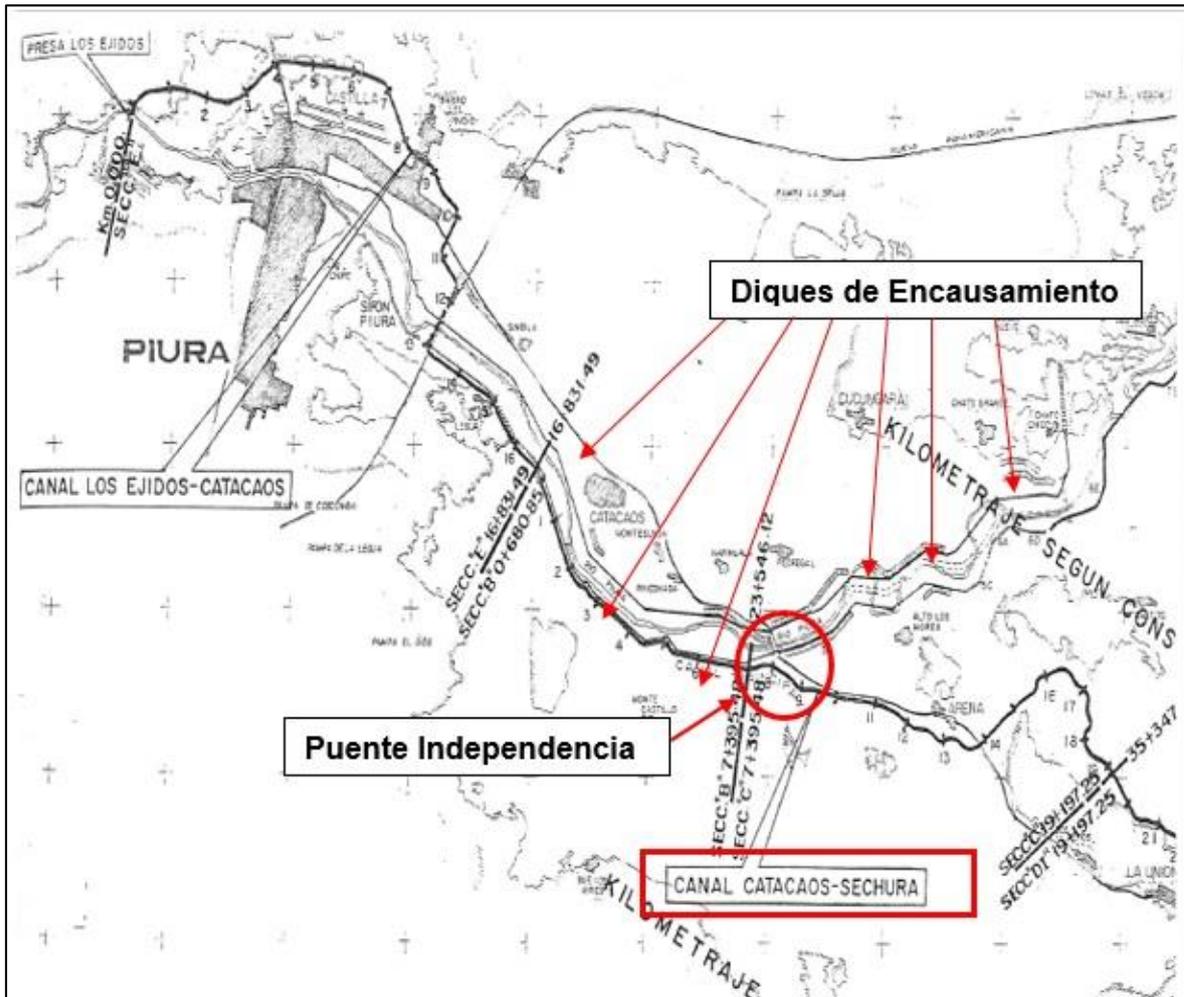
Plano del proyecto rehabilitación del bajo Piura.
